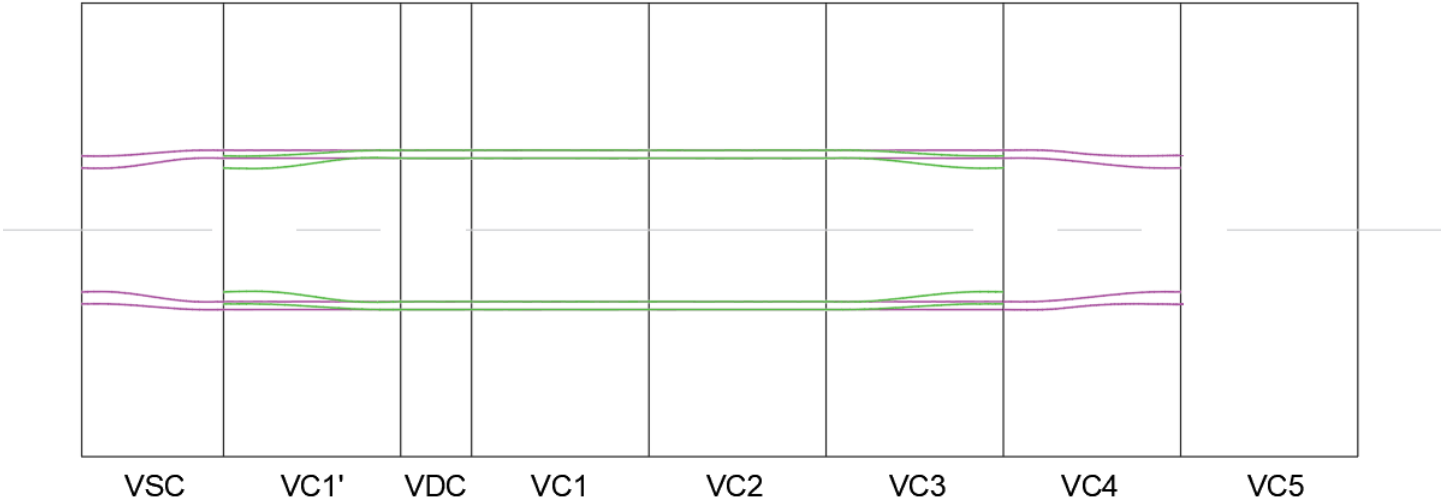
Tracé en plan des câbles de continuité en travée de rive
